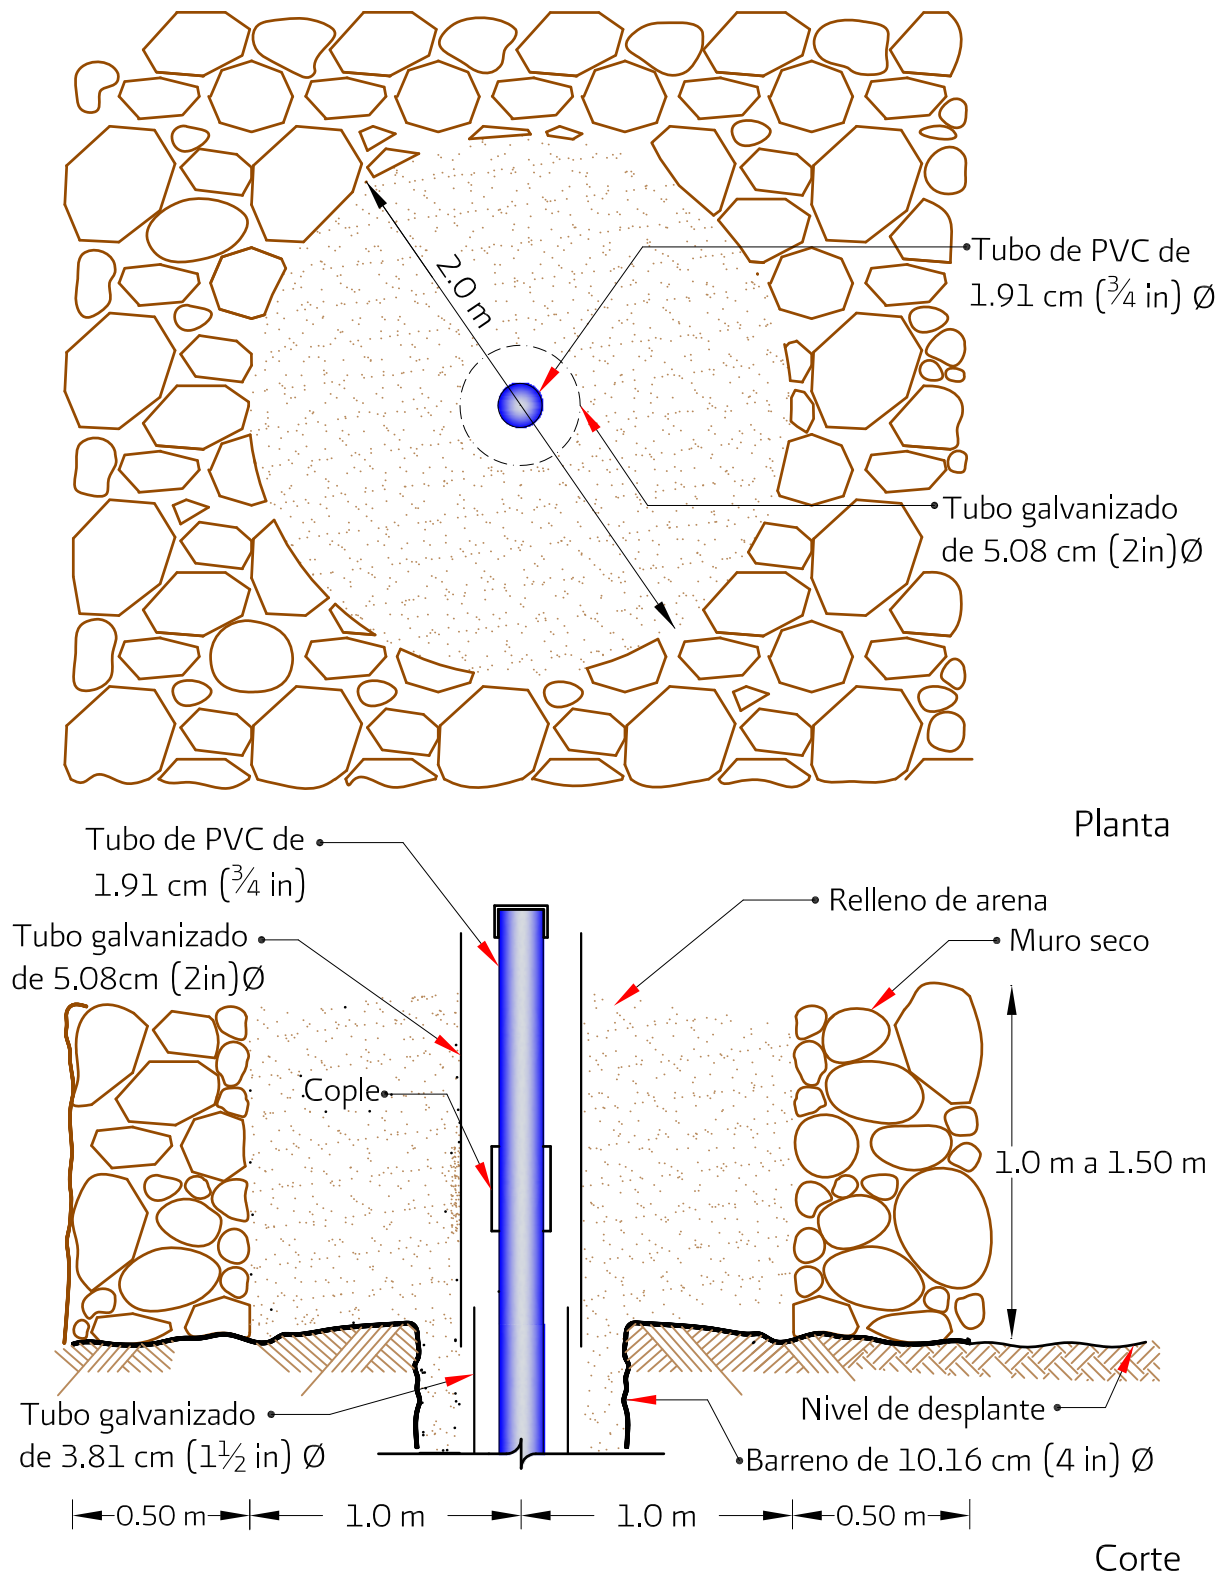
Cerco de piedra para protección de la tubería de piezómetro abierto que atraviesa materiales gruesos de rezaga o rocas en respaldo
